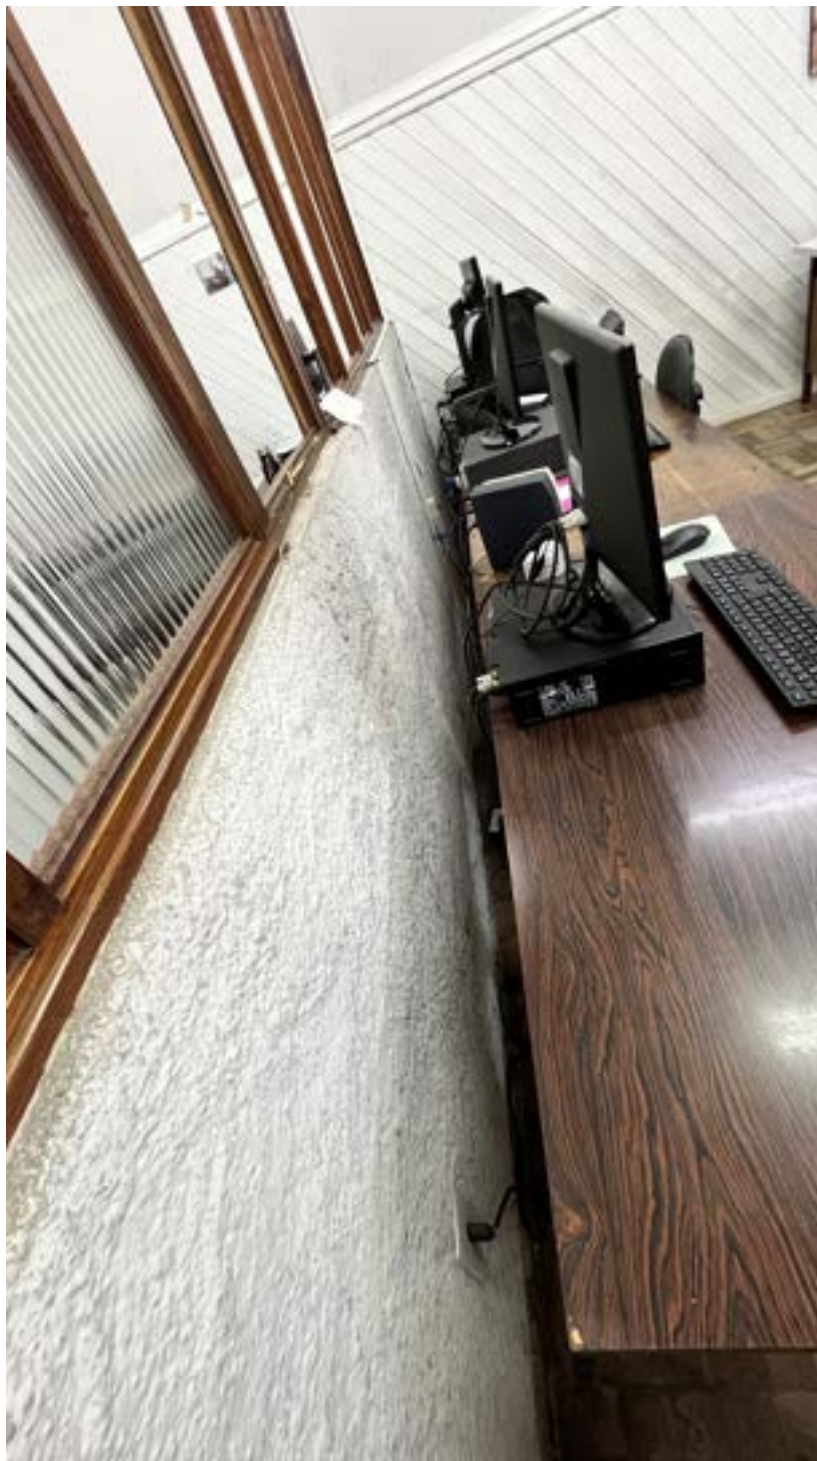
SUBÁREA A - Canaletas existentes e tomadas elétricas existentes
